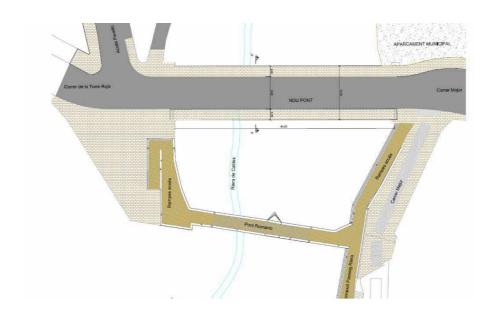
Planta general final de los dos puentes. Estudio previo.
